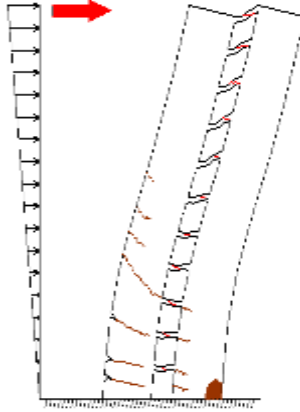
Falla por Corte o ruptura Diagonal de las vigas de conexión.
